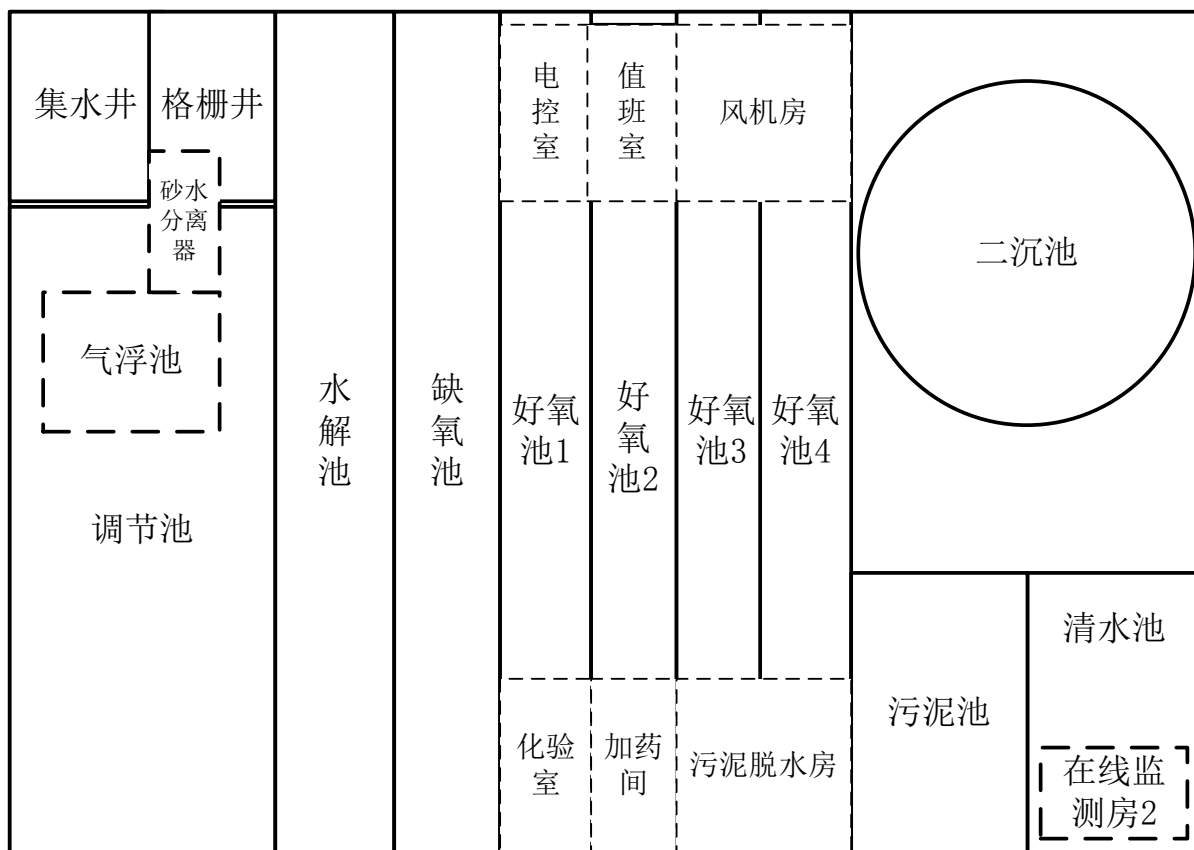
项目平面布置图（虚线部分为二层建筑）
